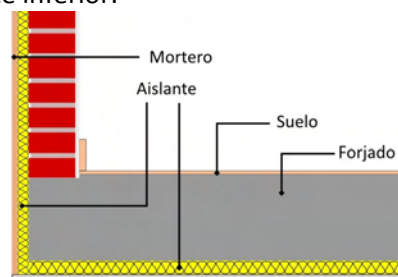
PT encuentro suelo-fachada. Aislamiento exterior (SATE)
